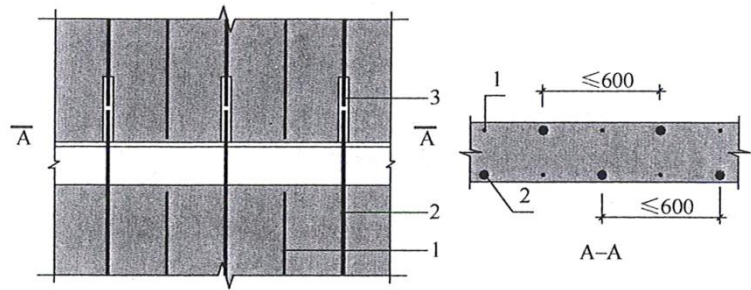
预制剪力墙竖向分布钢筋连接构造示意
